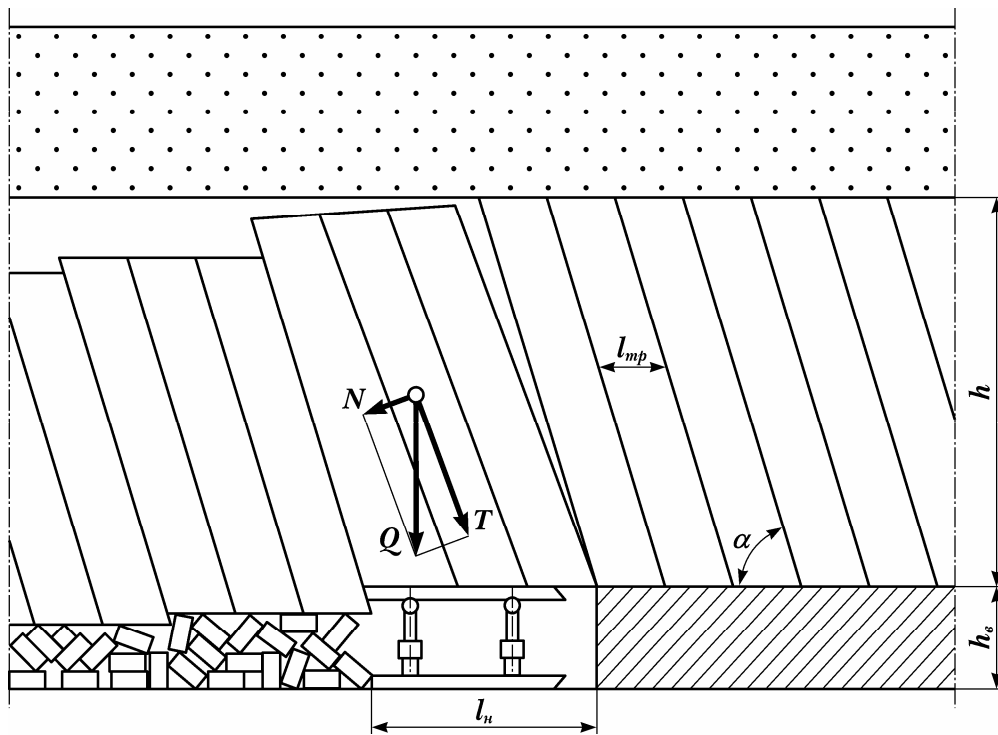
Схема к расчету механизированной крепи при трещинах непосредственной кровли, падающих на забой
